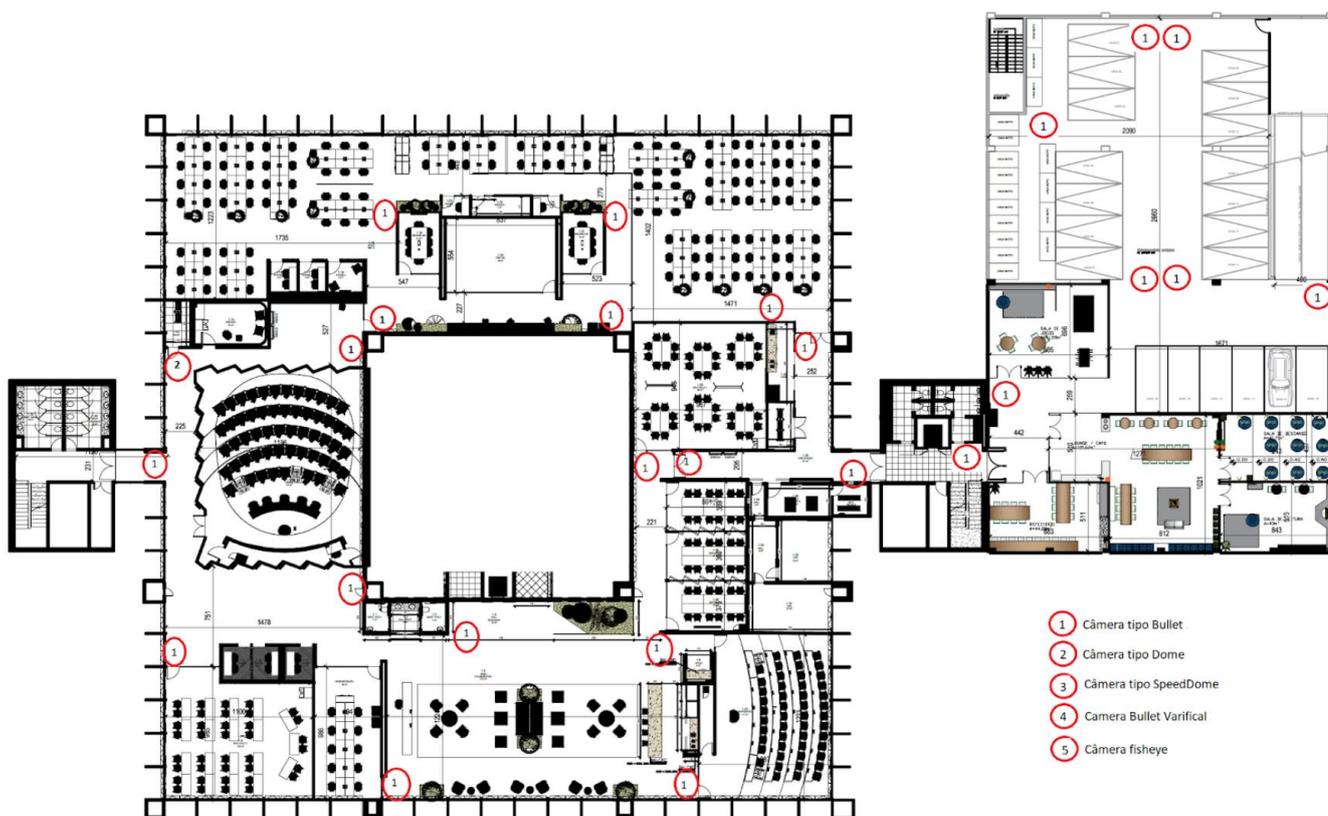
Esboço de posicionamento de câmeras para o primeiro pavimento prédio principal;
